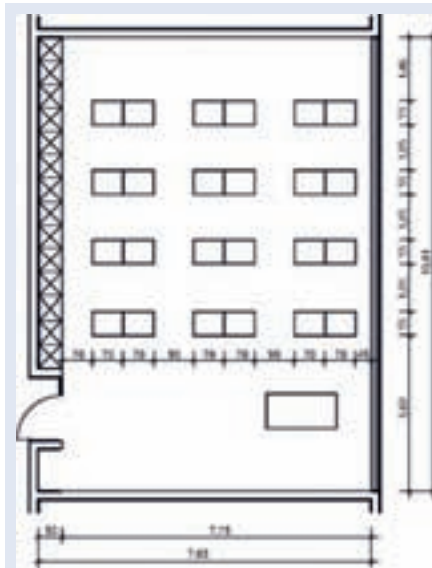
Grundriss und Ausstattung der Klassenräume
